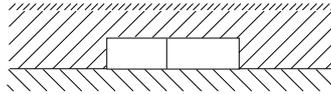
Système de conduits profilés ou système de goulottes pour installation dans le sol – installé sous un faux plancher
